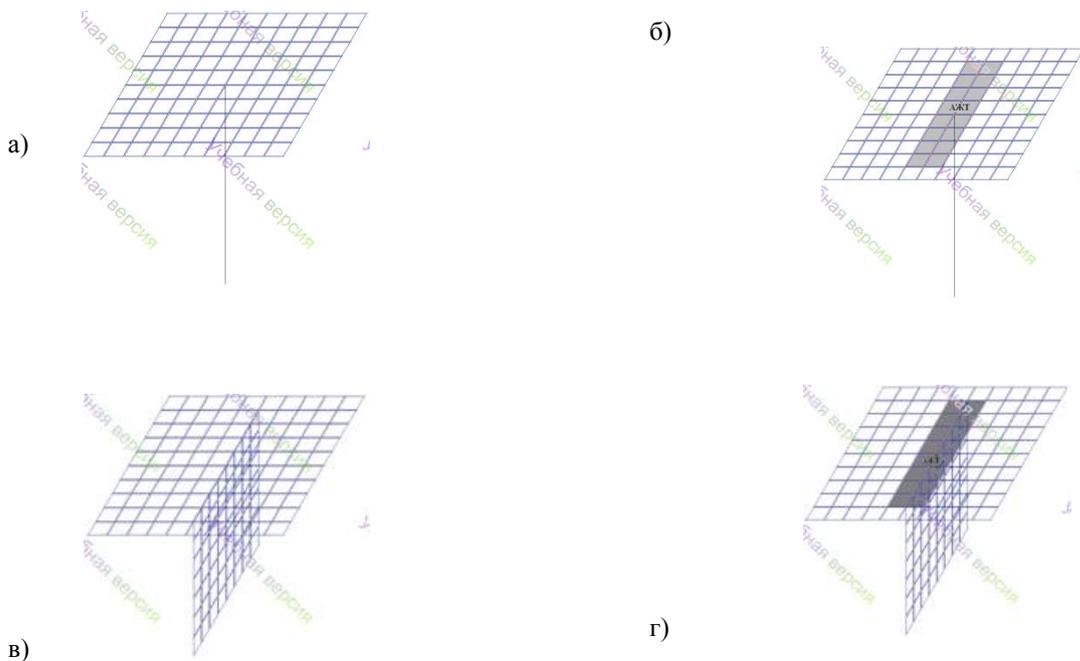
Узлы сопряжения вертикальных элементов с плитами перекрытий: а) стержень без использования АЖТ; б) стержень с использованием АЖТ; в) вертикальный элемент из пластин, без использования АЖТ; г) вертикальный элемент из пластин, с использованием АЖТ
